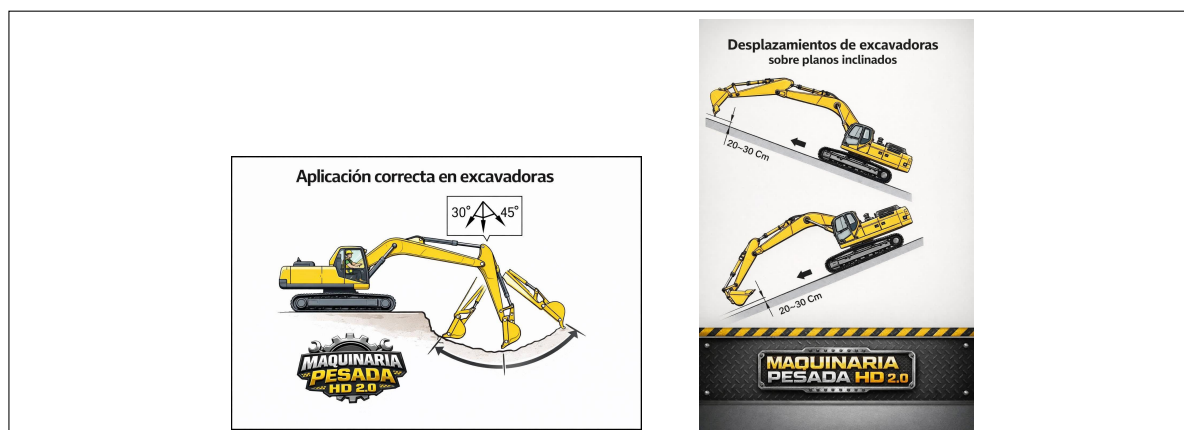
Aplicação correta na operação de escavadeira hidráulica e deslocamento de escavadeiras em plano inclinado. Fonte: Máquinas Pesadas HD 2.0.
